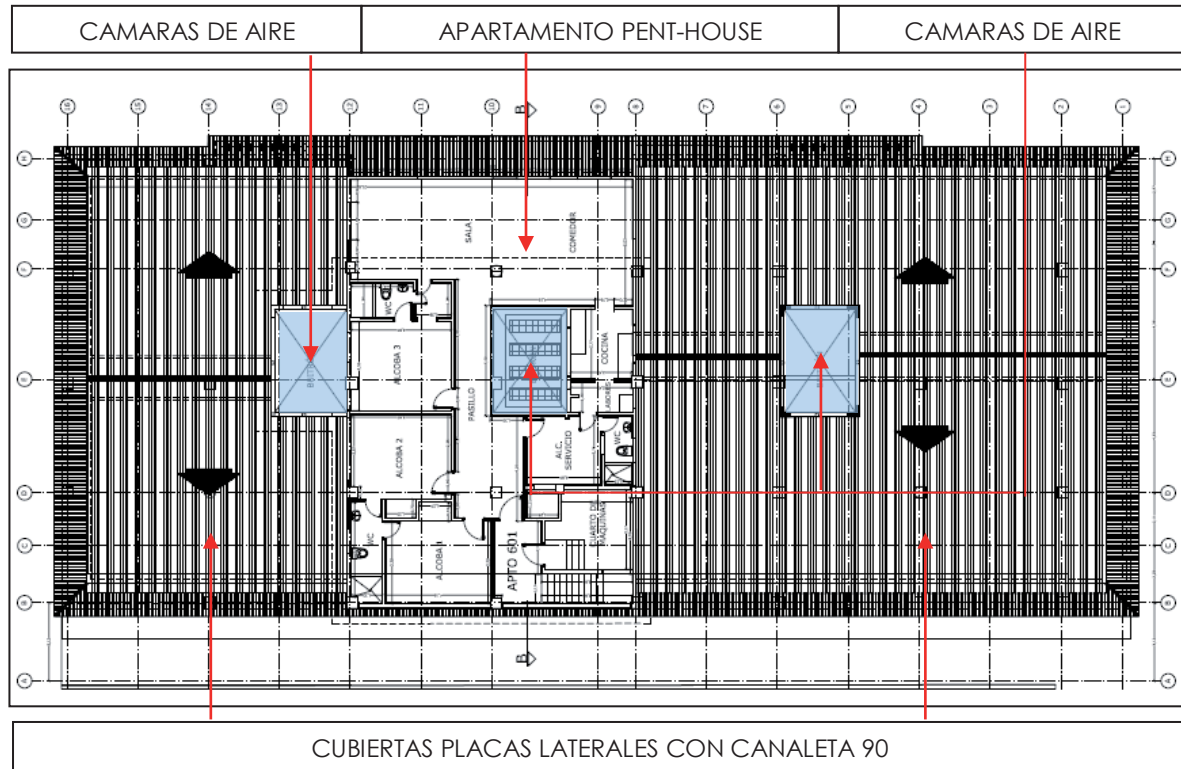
Planta Implantación General “Edificio David”. Fuente: Planos Plano estructura urbana predial del centro comercial y financiero de La Matuna, archivo personal, 2016.
